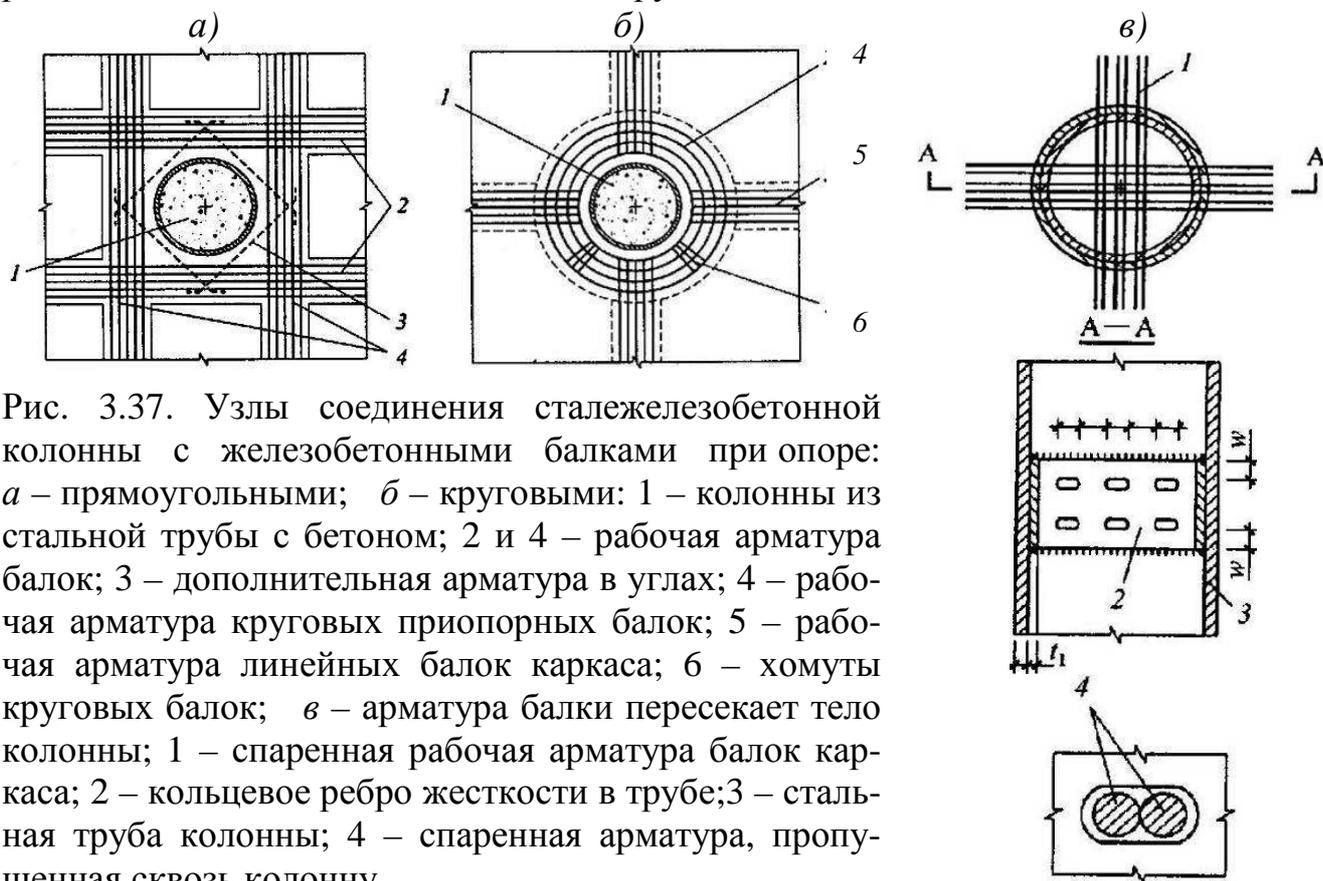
Узлы соединения сталежелезобетонной колонны с железобетонными балками при опоре: *а* – прямоугольными; *б* – круговыми: 1 – колонны из стальной трубы с бетоном; 2 и 4 – рабочая арматура балок; 3 – дополнительная арматура в углах; 4 – рабочая арматура круговых приопорных балок; 5 – рабочая арматура линейных балок каркаса; 6 – хомуты круговых балок; *в* – арматура балки пересекает тело колонны; 1 – спаренная рабочая арматура балок каркаса; 2 – кольцевое ребро жесткости в трубе; 3 – стальная труба колонны; 4 – спаренная арматура, пропущенная сквозь колонну
